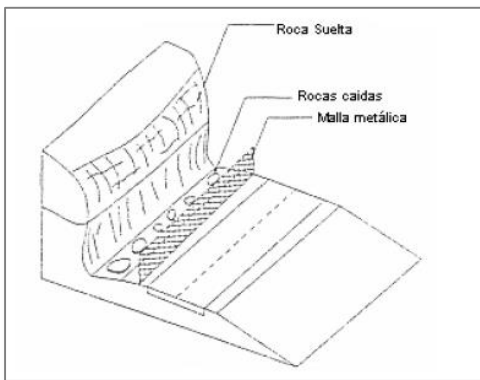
Protección con defensa de malla metálica (Suárez, 1998)
